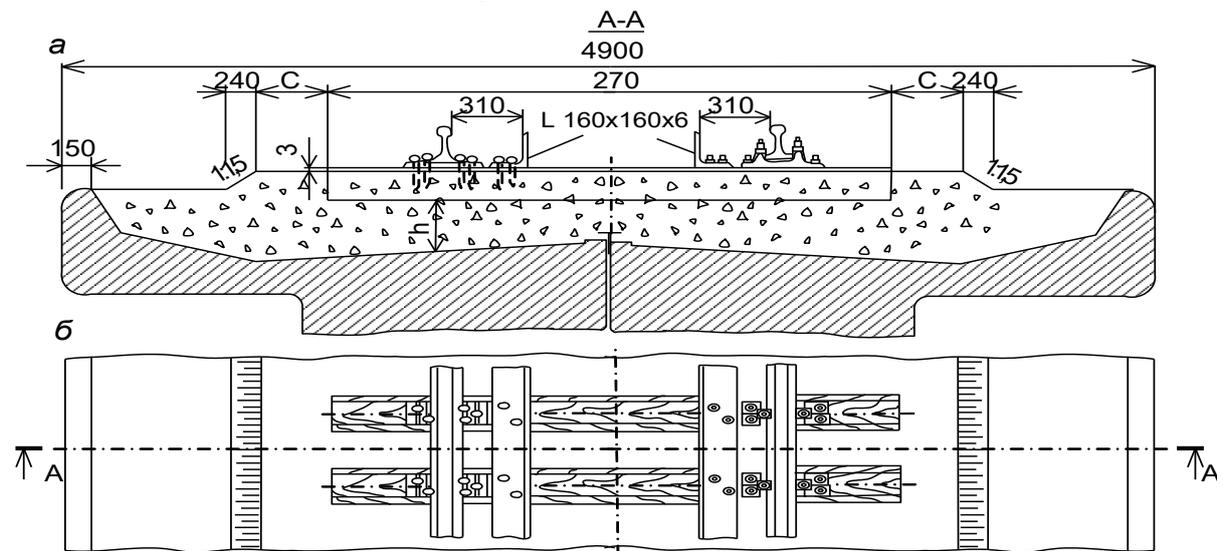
Конструкция мостового полотна с ездой на щебеночном балласте и деревянных шпалах: а – поперечное сечение; б – план; h – толщина балласта
